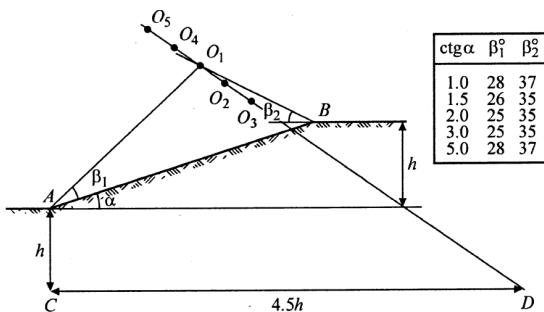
Схема к поиску центров круглоцилиндрической поверхности скольжения [2]
